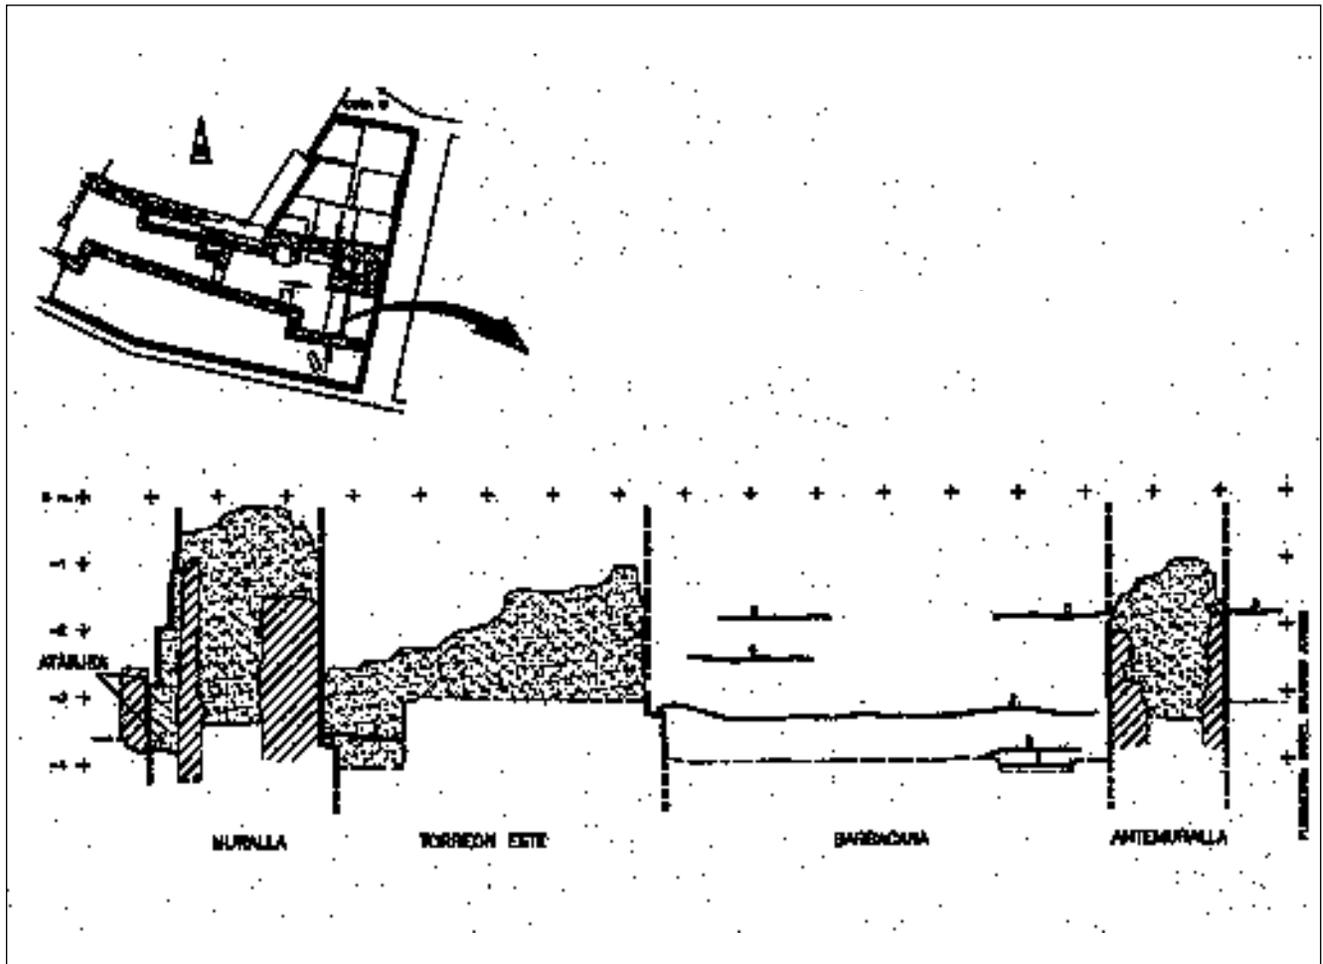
Sección de estructuras defensivas con pavimentos asociados.
